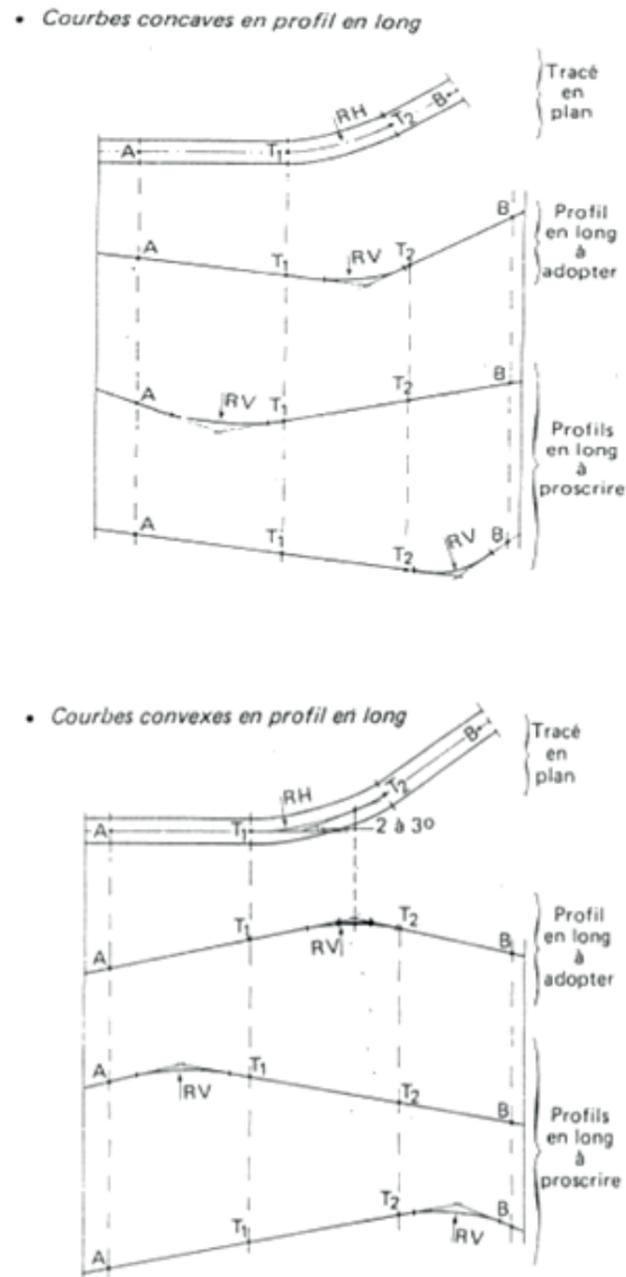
COORDINATION PROFIL EN LONG - TRACÉ EN PLAN
